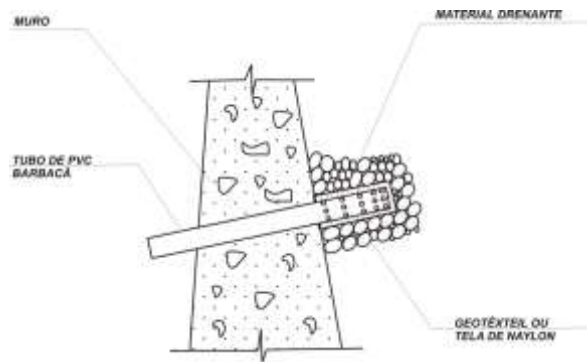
Projeto tipo 25 – Detalhes do barbacá.
